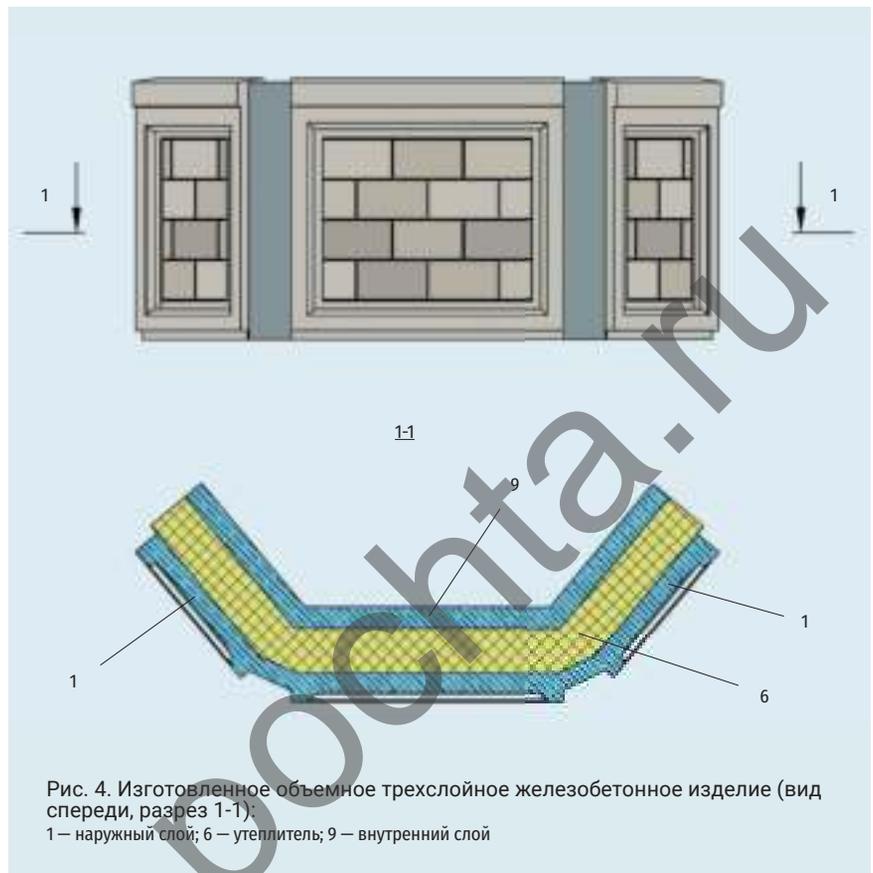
Изготовленное объемное трехслойное железобетонное изделие (вид спереди, разрез 1-1):
